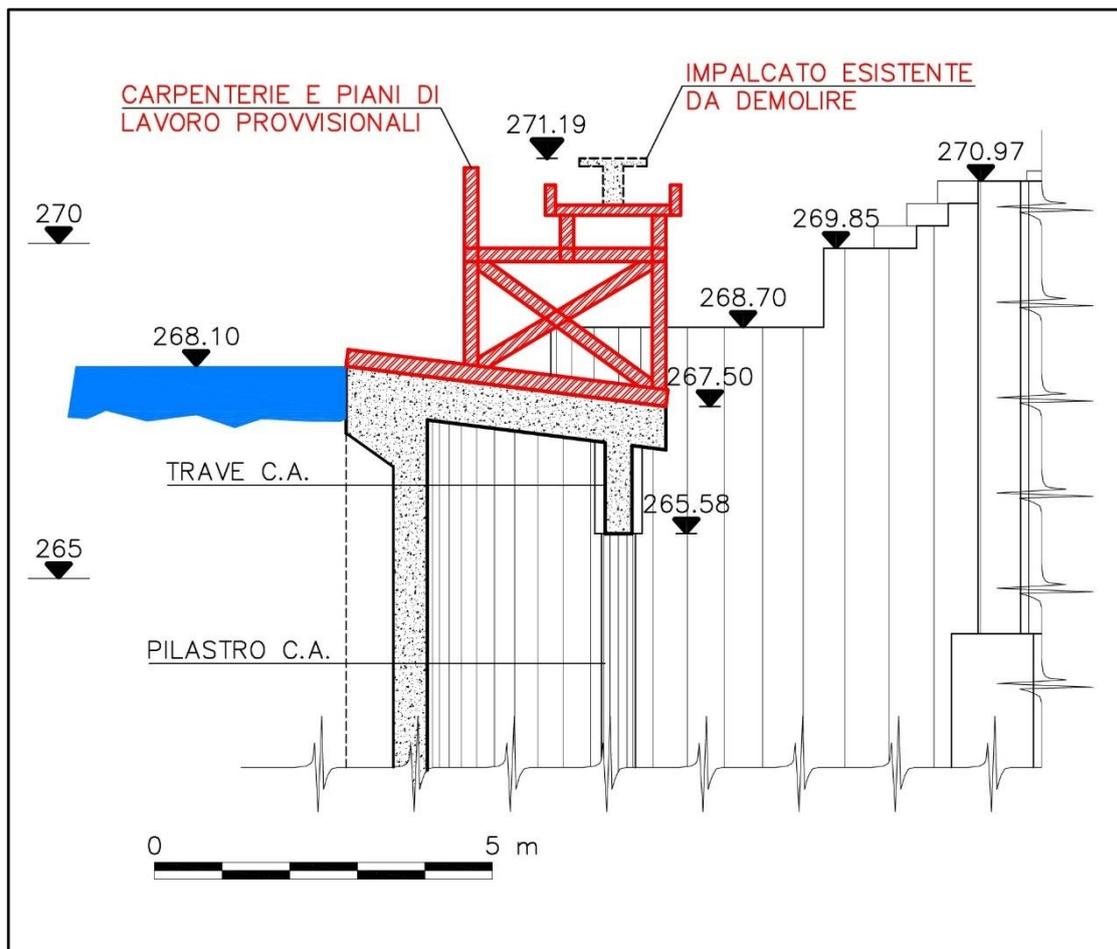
Sezione carpenterie e piani di lavoro provvisori
